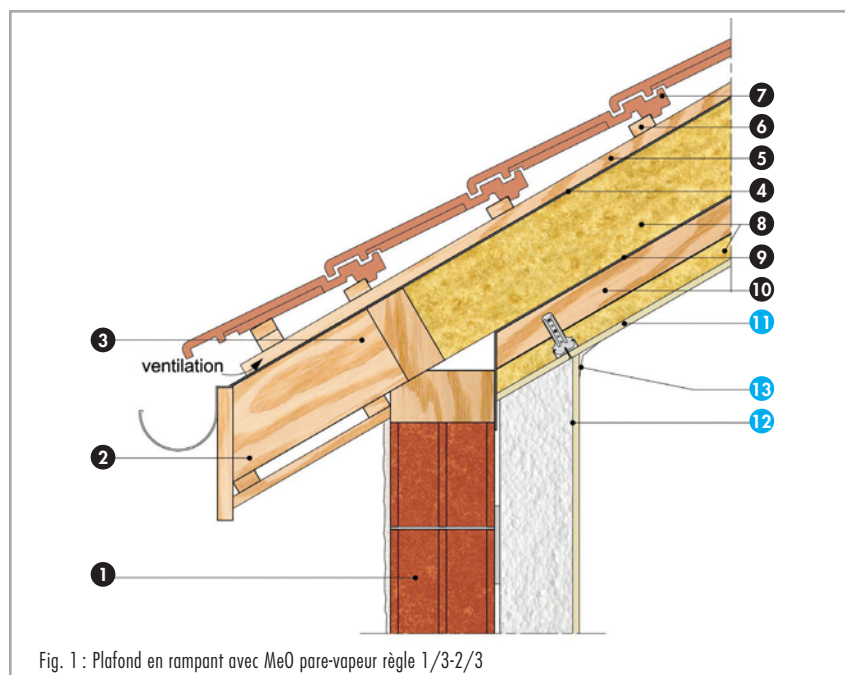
Plafond en rampant avec MeO pare-vapeur règle 1/3-2/3
